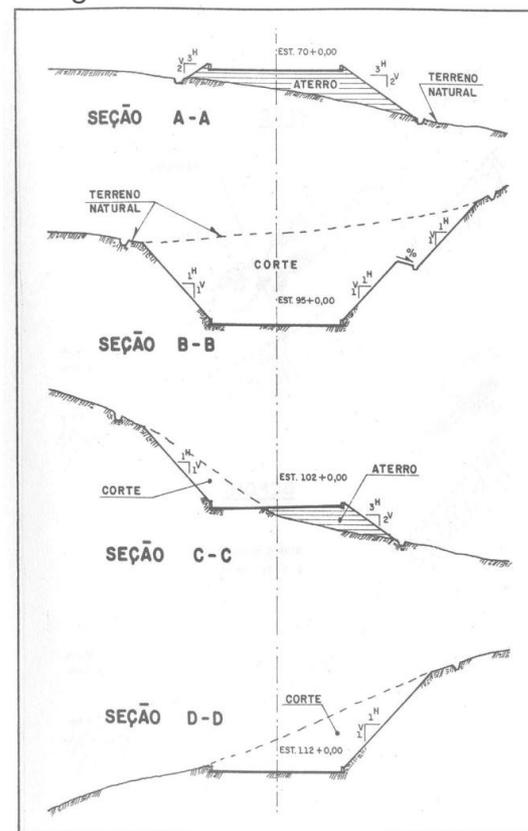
Seções transversais tipo de uma rodovia
